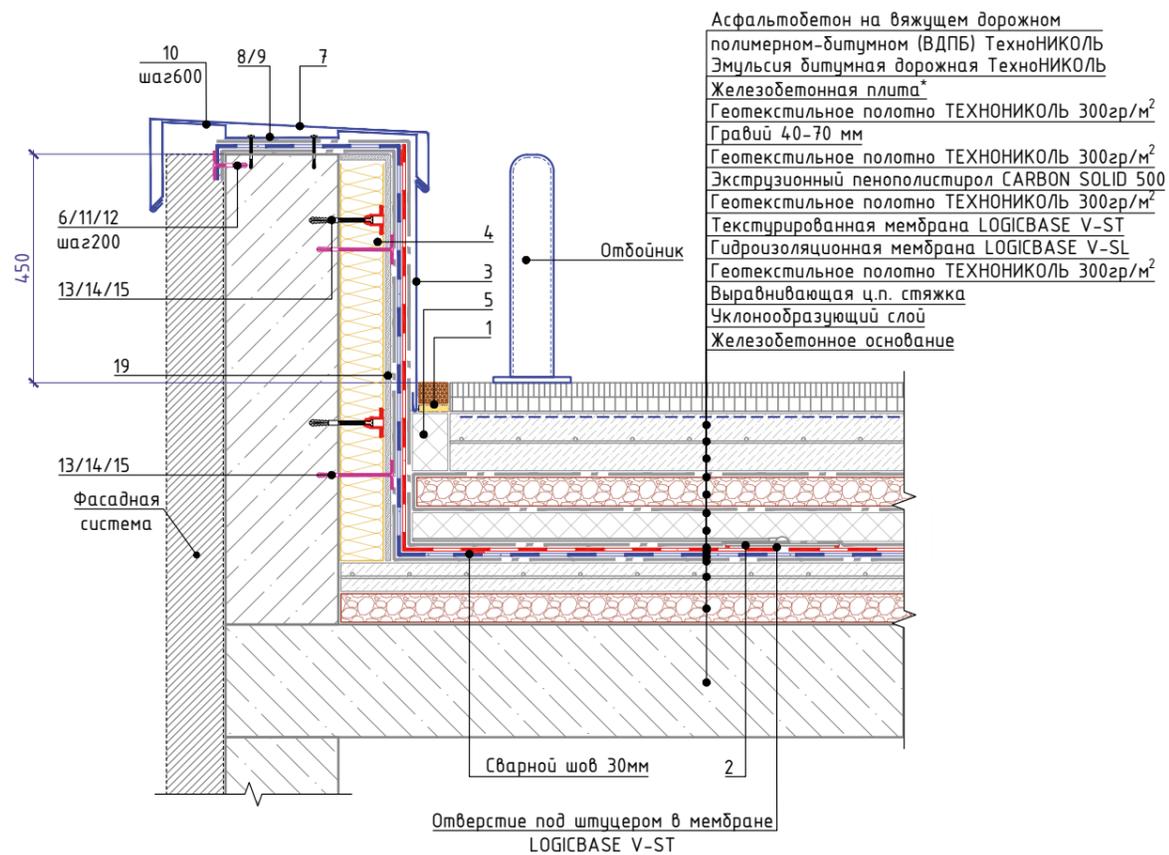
Примыкание к стене с системой вентилируемого фасада
